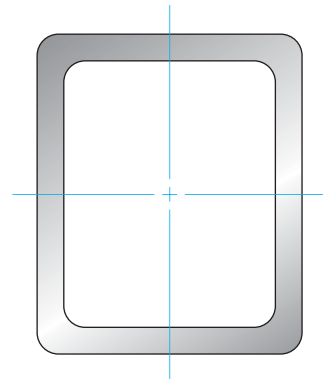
Perfil representativo de la sección transversal de un tubo rectangular hueco.
